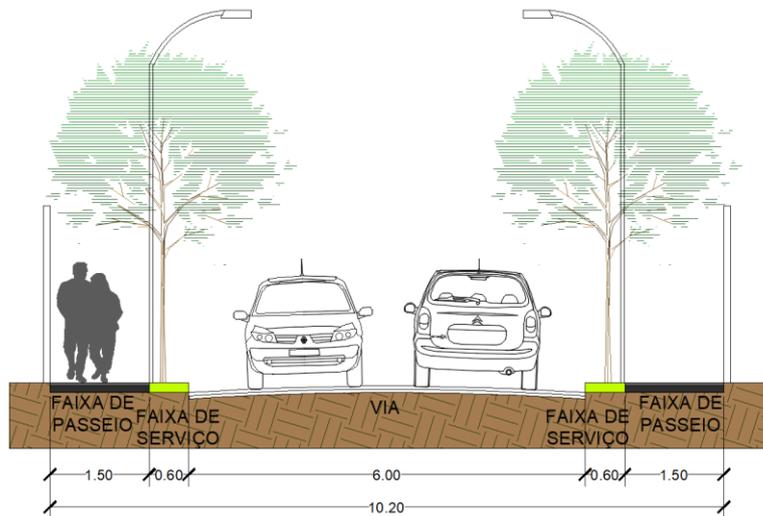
Perfil da Via de Circulação de Vizinhança 2 – Perfil 01 (Fonte: Própria)
